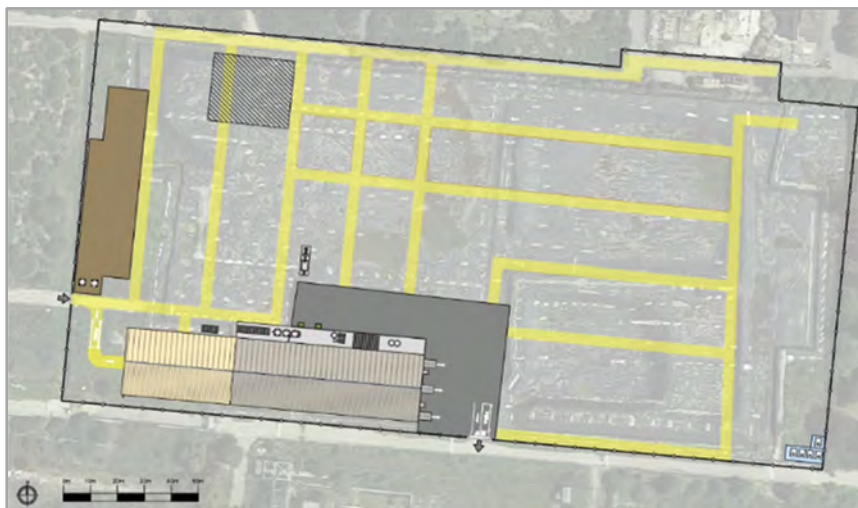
Planimetria dell'Area Palte con evidenziate in giallo le piste di cantiere.
